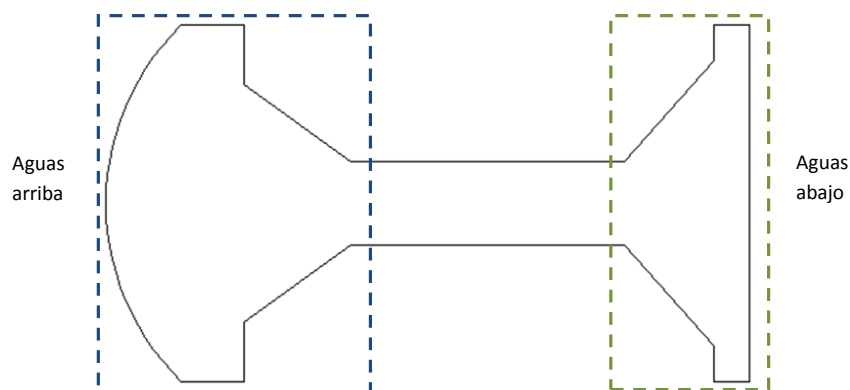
Planta de un bloque utilizada para determinar las características de las barras
